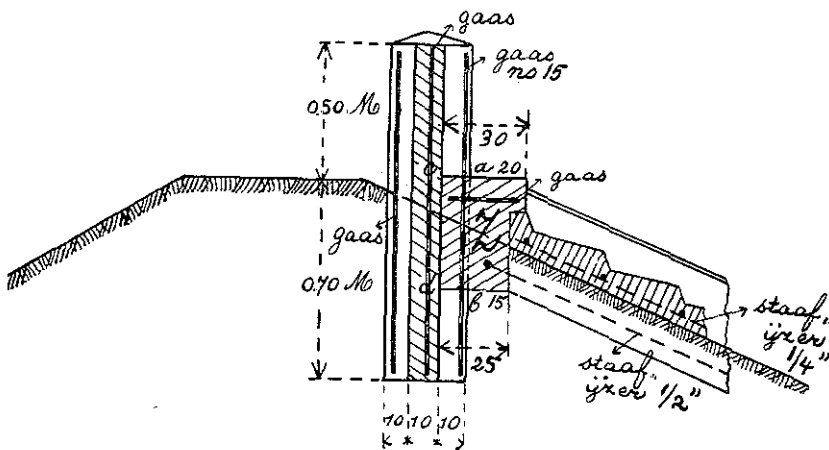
Ontwerp van een betondijksverhooging van penantepijlers en betonplanken met aansluitende taludverdediging
